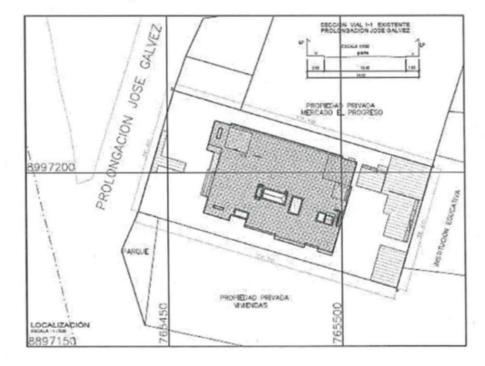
Plano de Ubicación en Planta del Proyecto Fuente: Expediente Técnico
